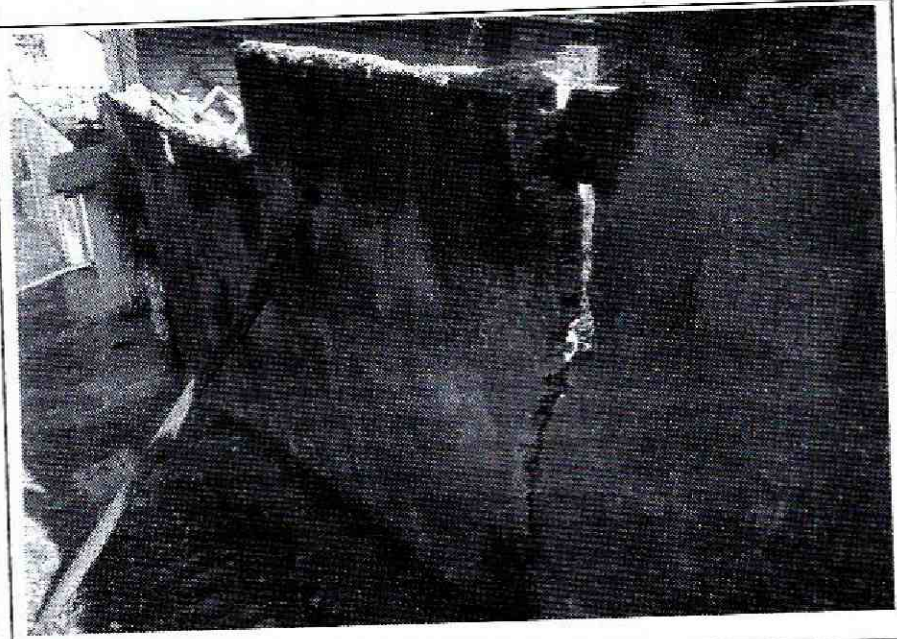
Fractura y pérdida de verticalidad en la parte central del muro.
